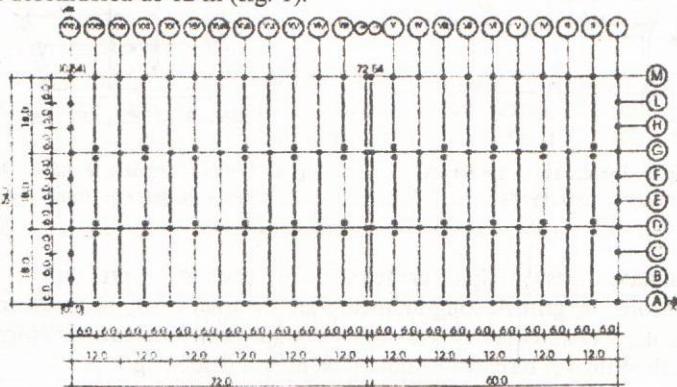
Plan de poziționare a cadrelor transversale și a grinzelor jug.
